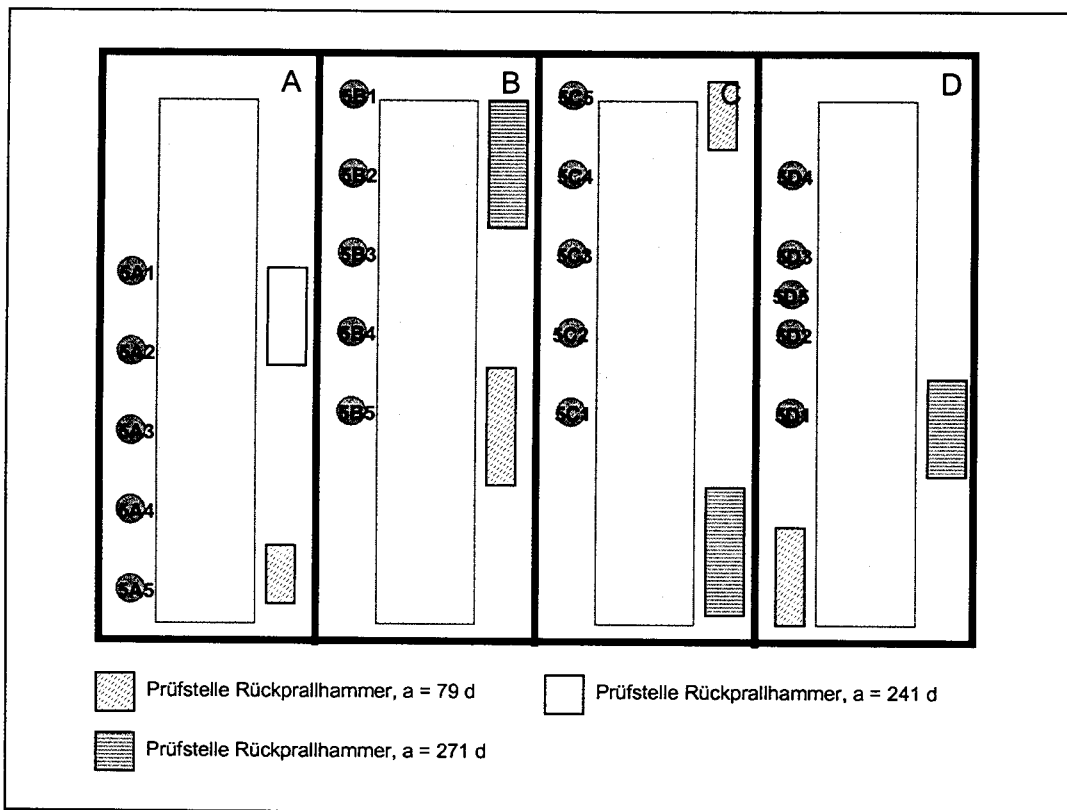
Lage der Prüfflächen am Betonkörper 5
